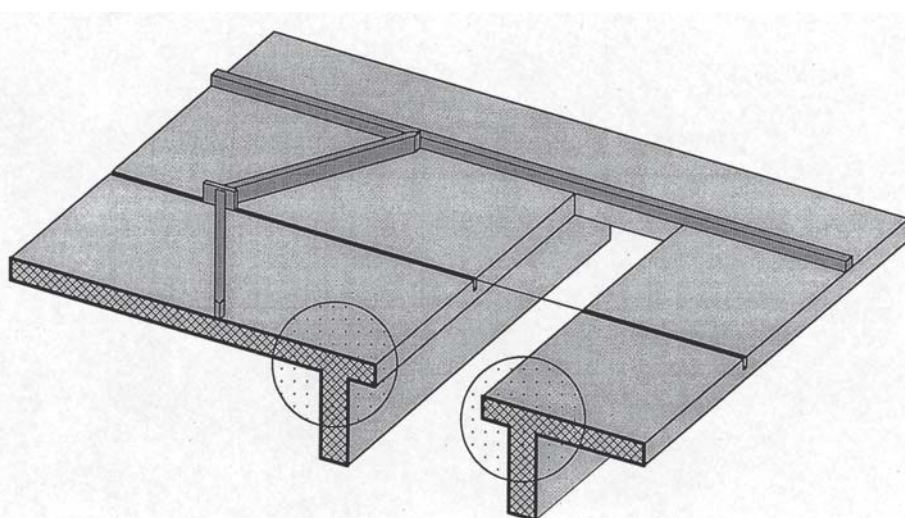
Eine auskragende Konstruktion beim Abwurf des Faltschiebers verunmöglicht den Güllewürmern, an die Oberfläche zu gelangen.
